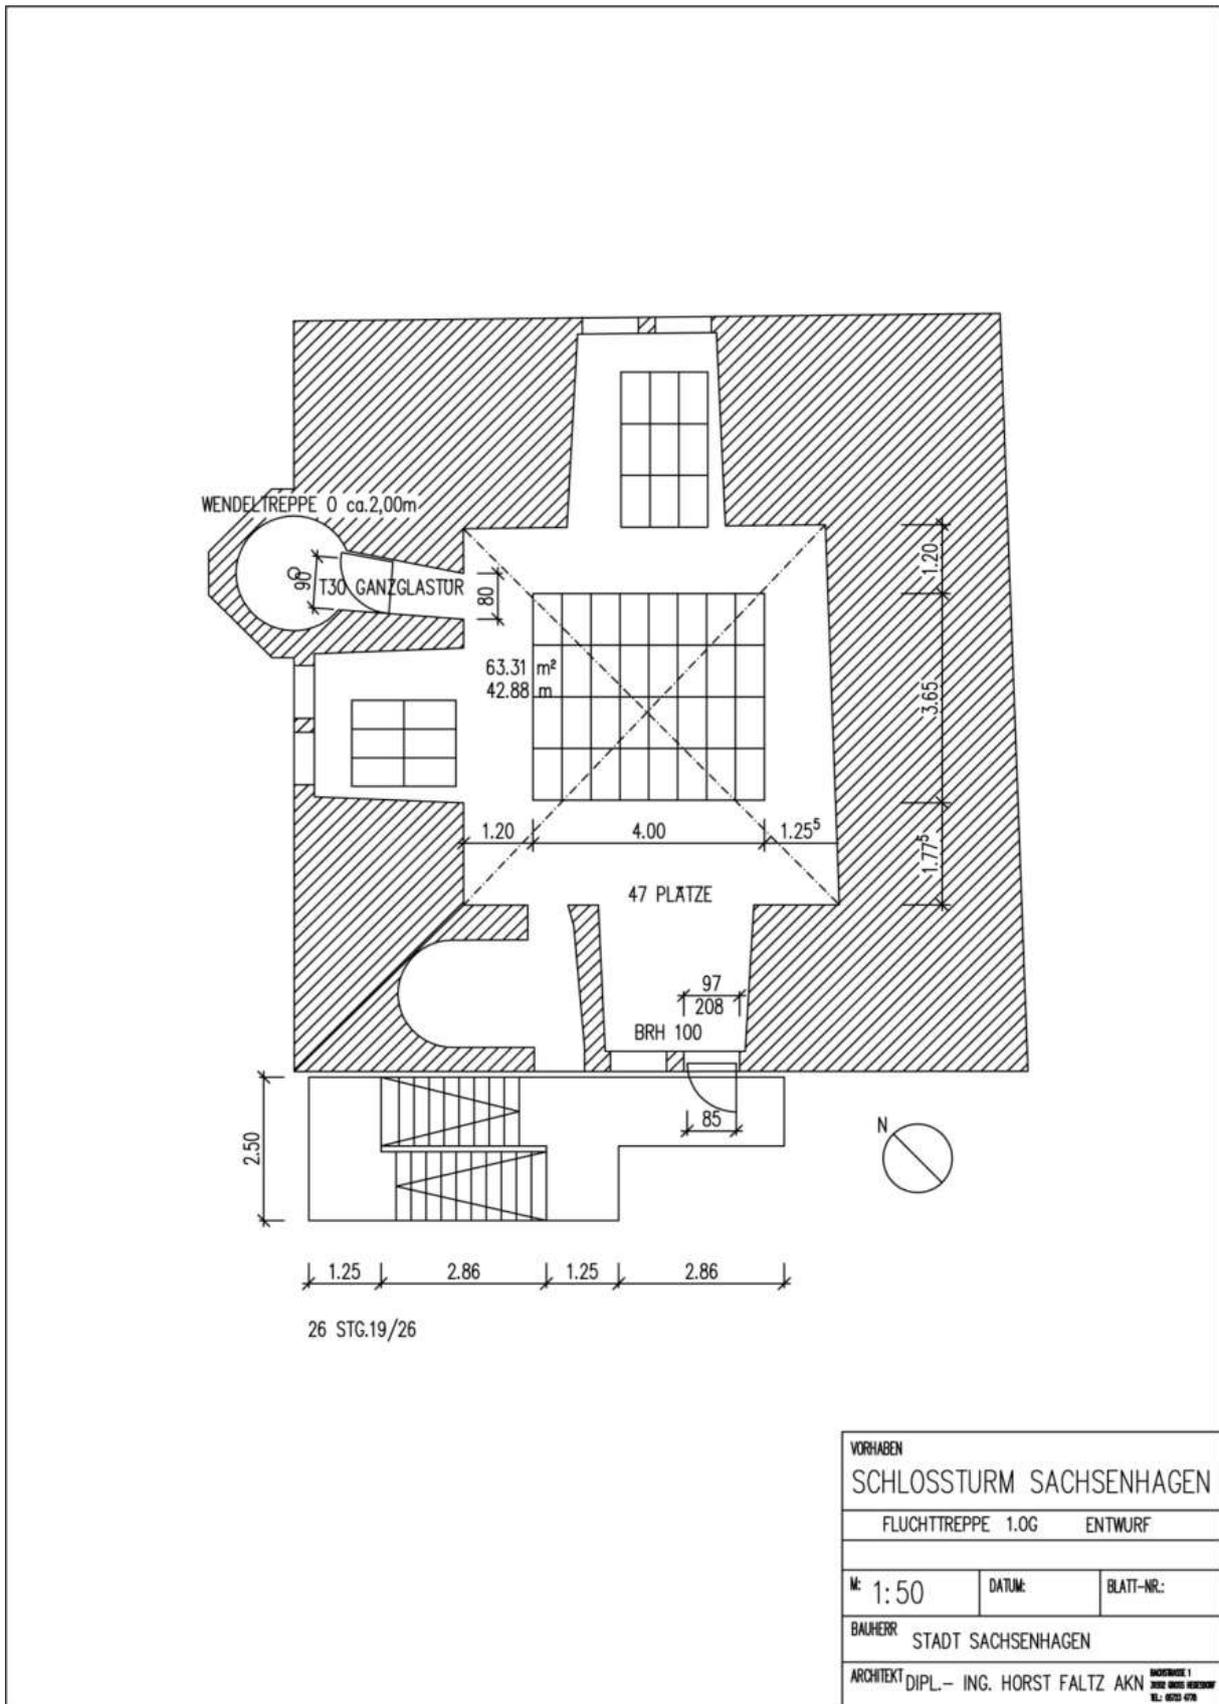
Grundriss 1. OG mit Bestuhlungsplan
